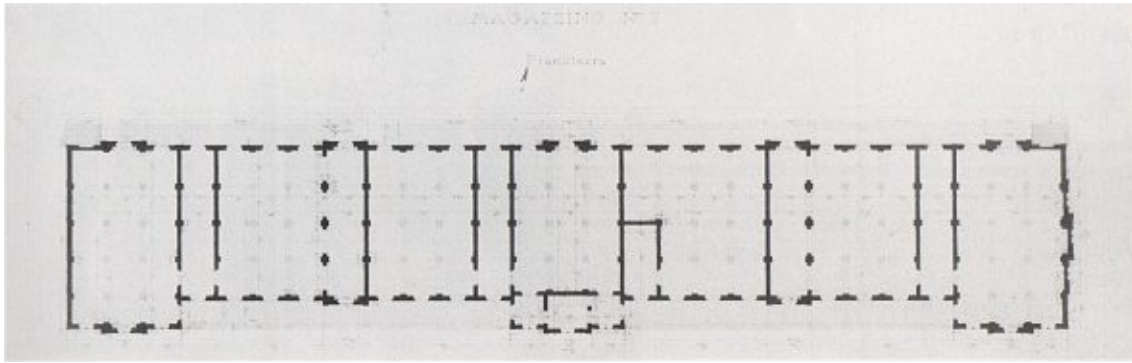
Lagerhaus 7, Grundriss.
